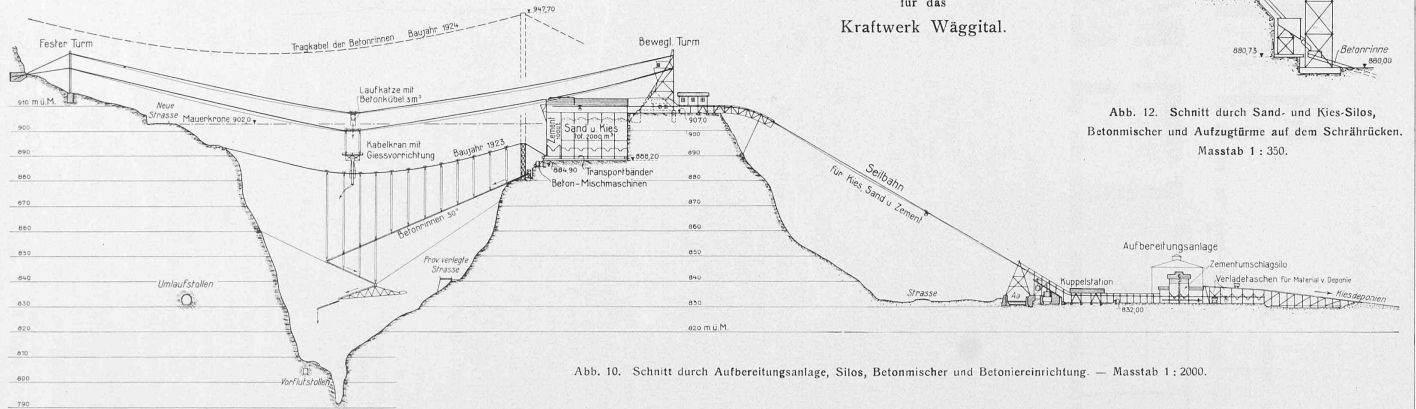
Schnitt durch Aufbereitungsanlage, Silos, Betonmischer und Betoniereinrichtung. — Masstab 1 : 2000.
